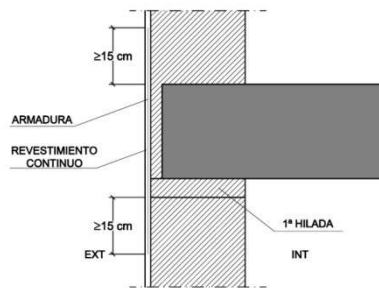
Ejemplo de arranque de la fachada desde la cimentación
